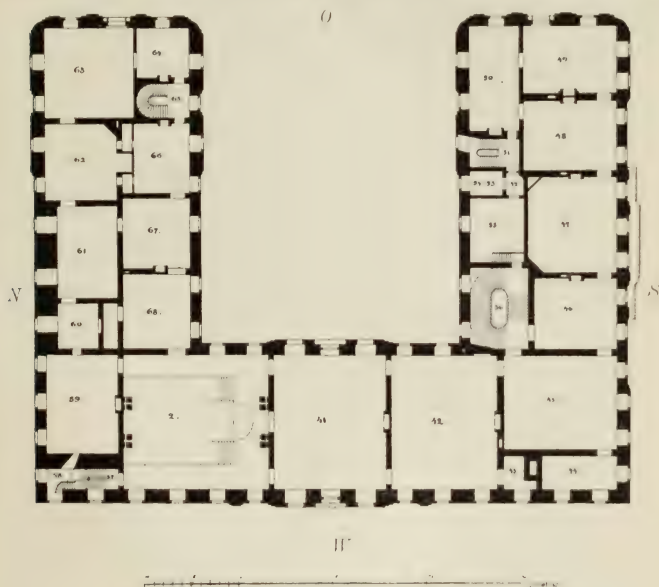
Schloss Brühl. Oberer Grundriss.
